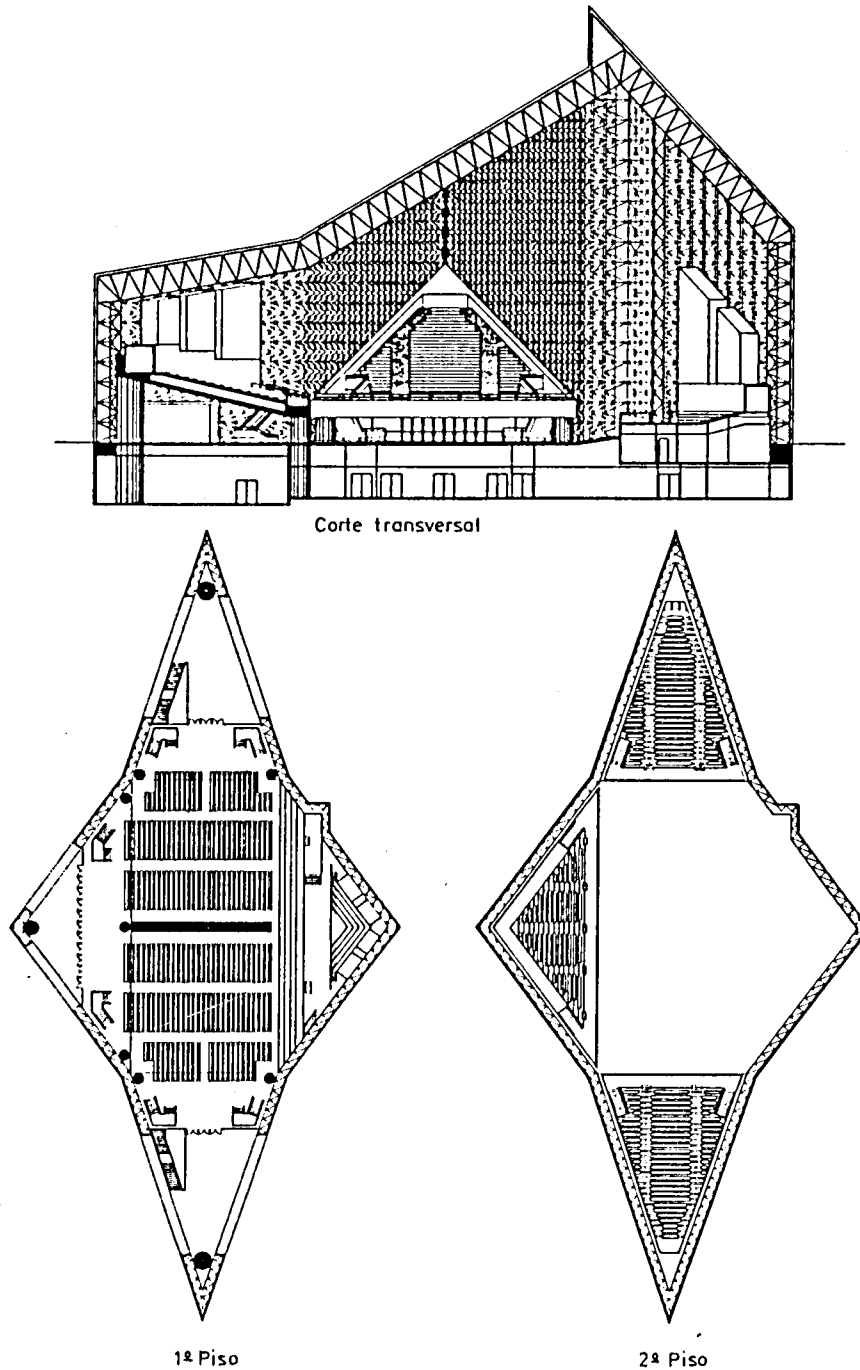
Desenho de um corte transversal e das plantas da Catedral de Cristal
